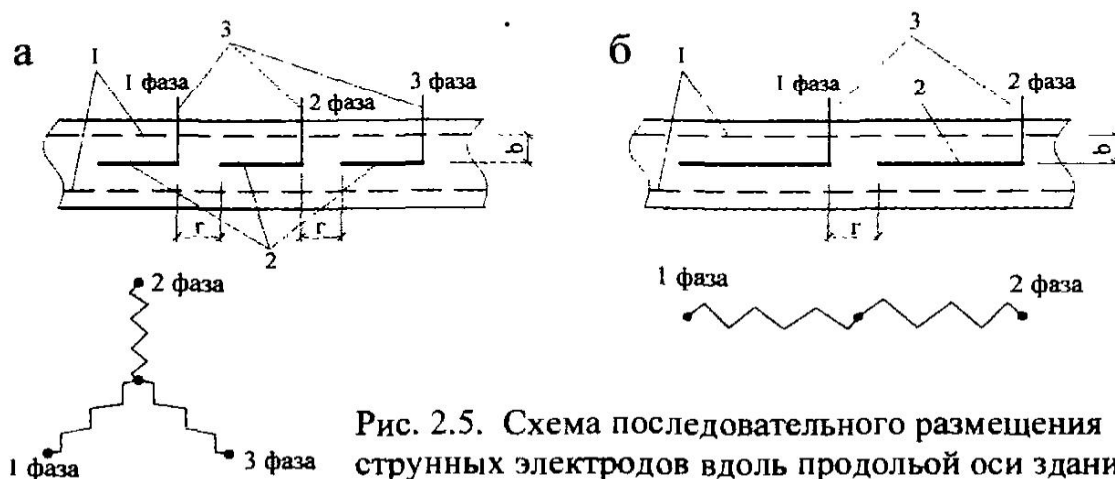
Схема последовательного размещения струнных электродов вдоль продольной оси здания
